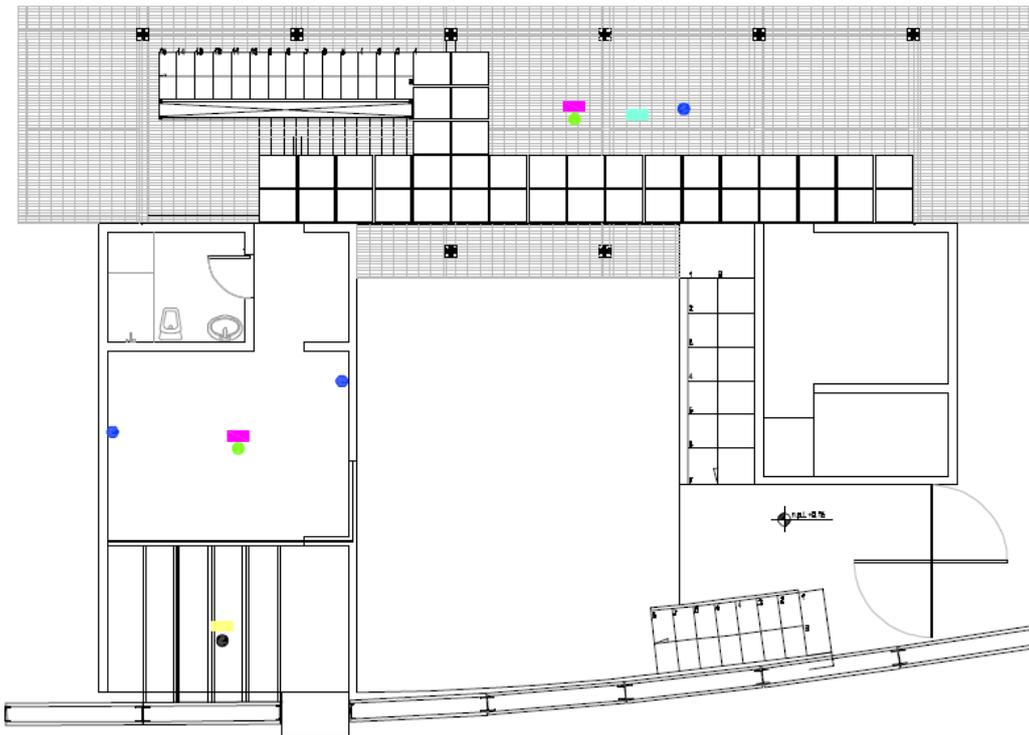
Localización de los sensores en planta alta de la vivienda 21 La Religa
